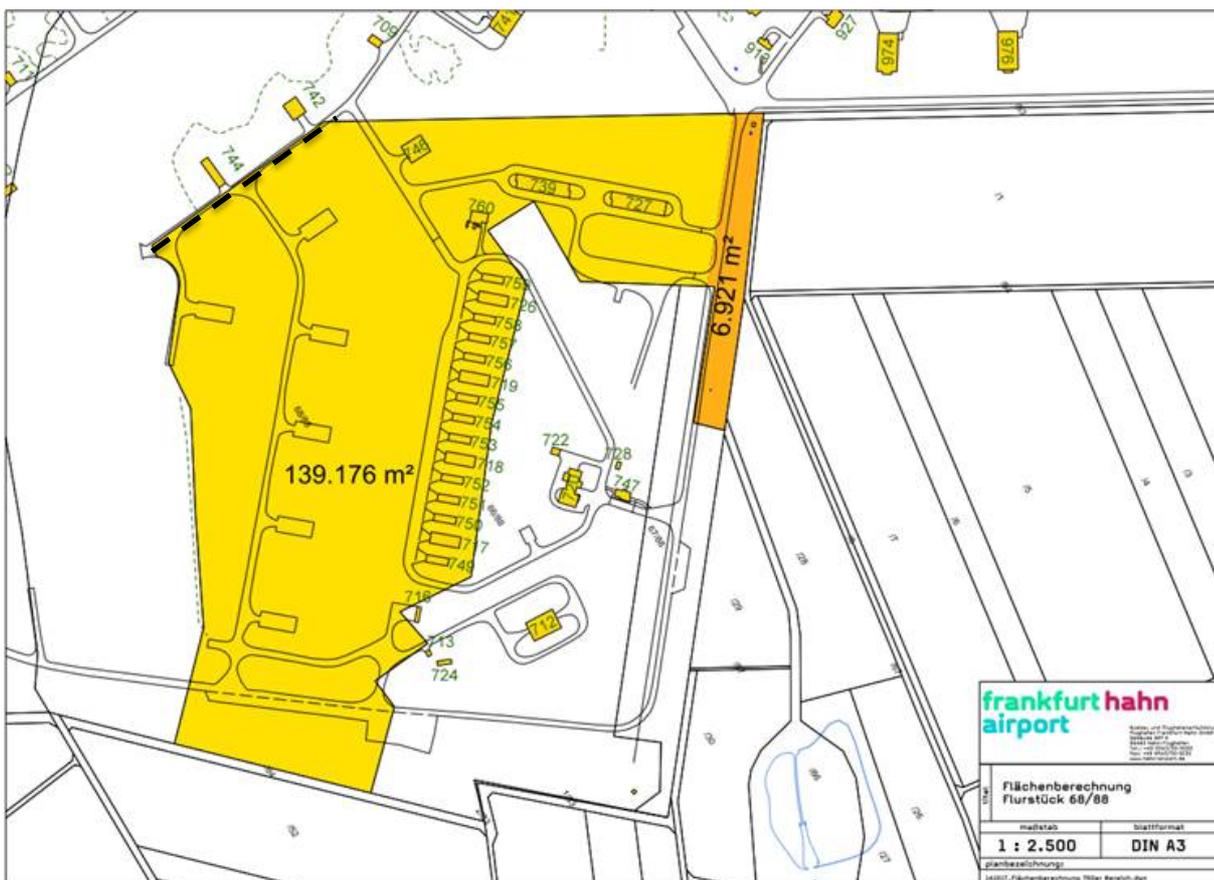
Grundstücksfläche 139.176 m² / Vorhabensfläche 138.067 m²
